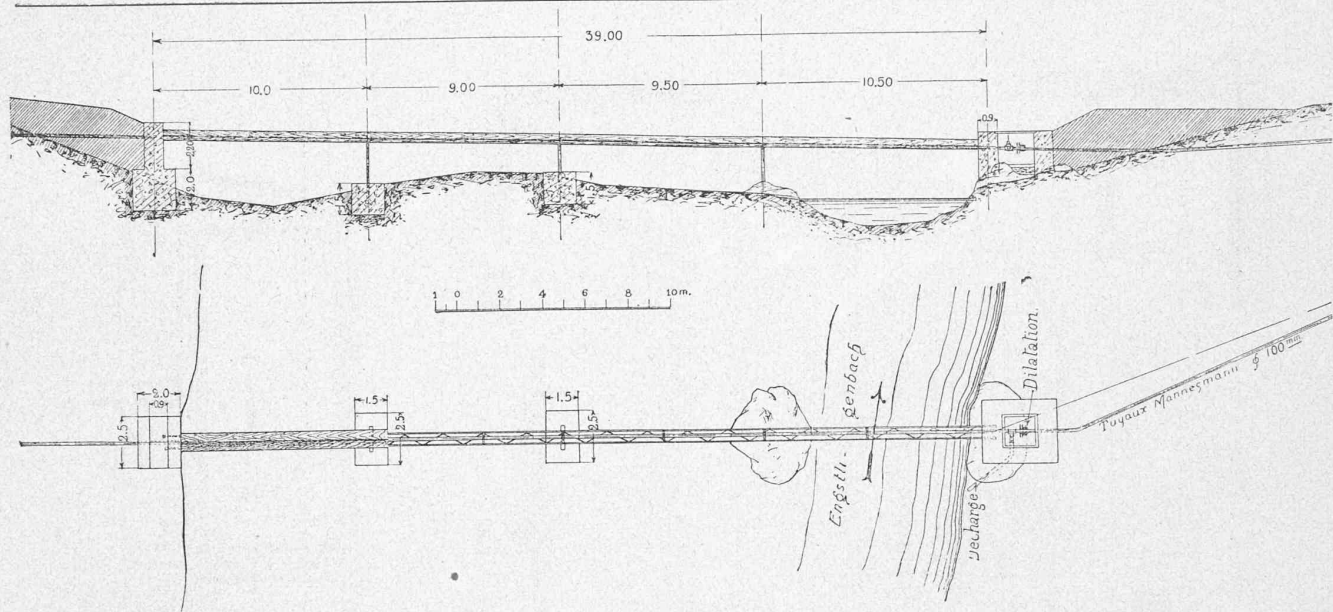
Elévation et plan de l'aqueduc sur le ruisseau d'Engstligen.
